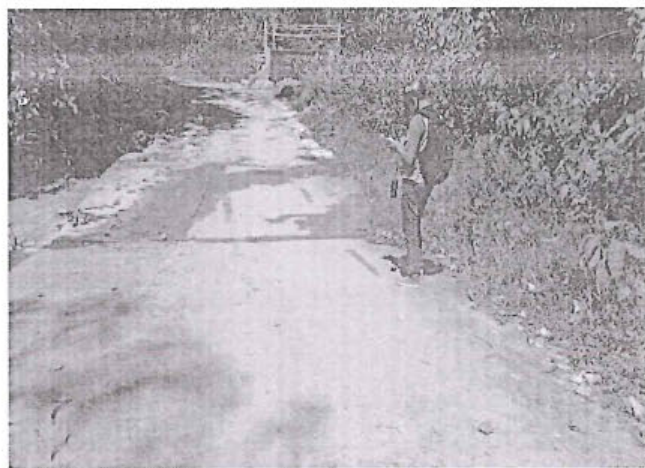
Baden en la prog. 11+420 y fin de pavimento en
